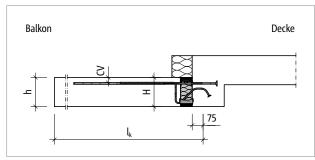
Schöck Isokorb® T Typ KL-U: Statisches System
